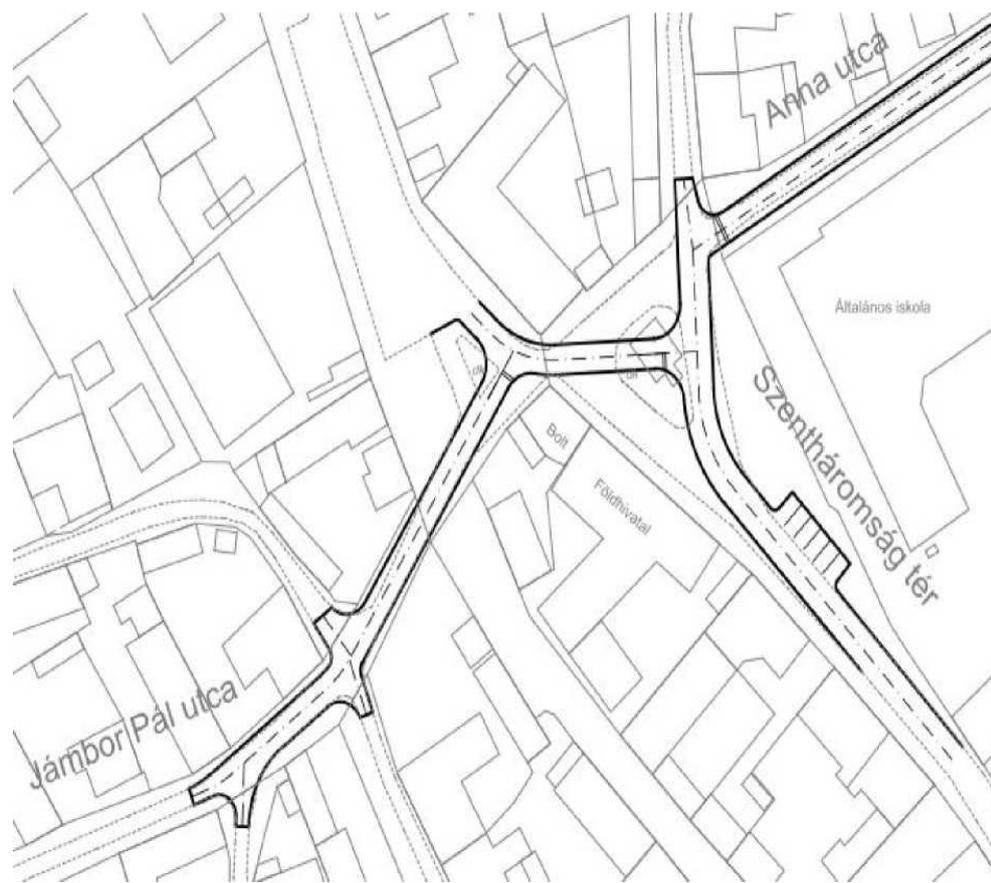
Рекомендуемая конструкция пл. Сентхаромшаг, схема плана
